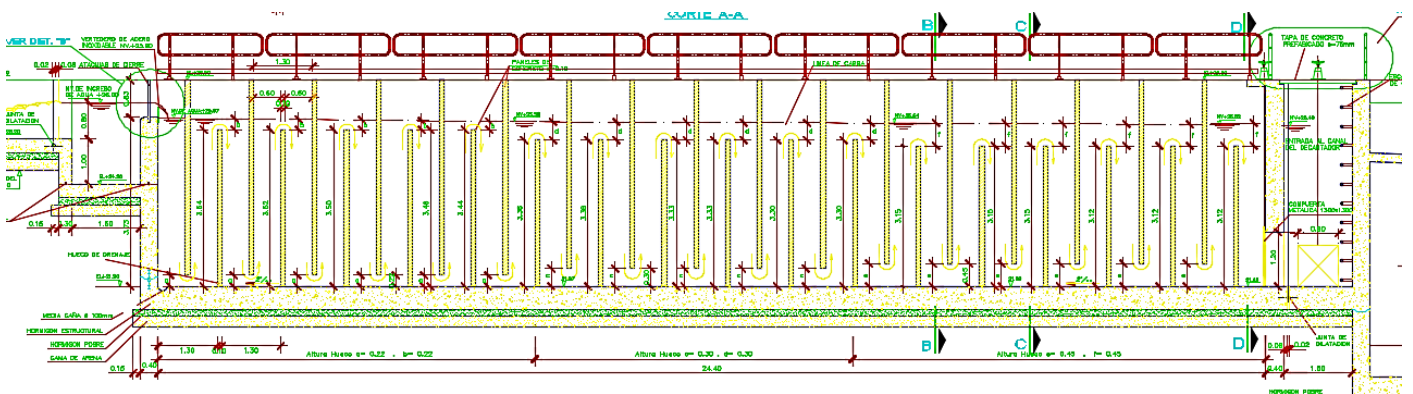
Vista en corte de los floculadores de la P.T.A.P de Barrera de Salinidad
